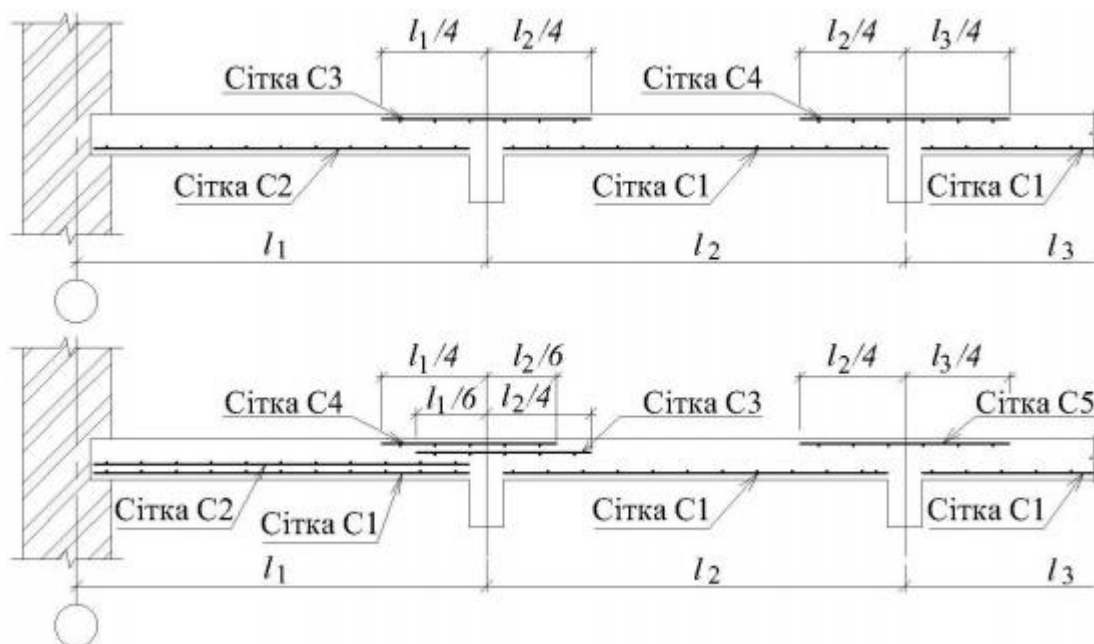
Армування плит зварними сітками з поперечною робочою арматурою (варіанти)
